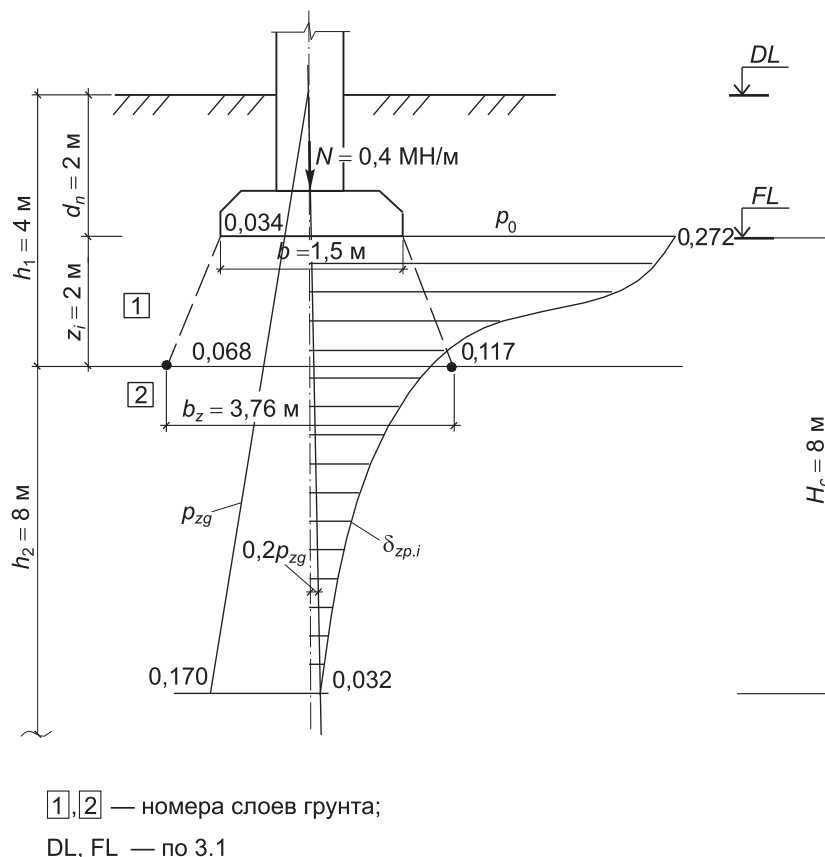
Расчетная схема основания фундамента к примеру Г.8
